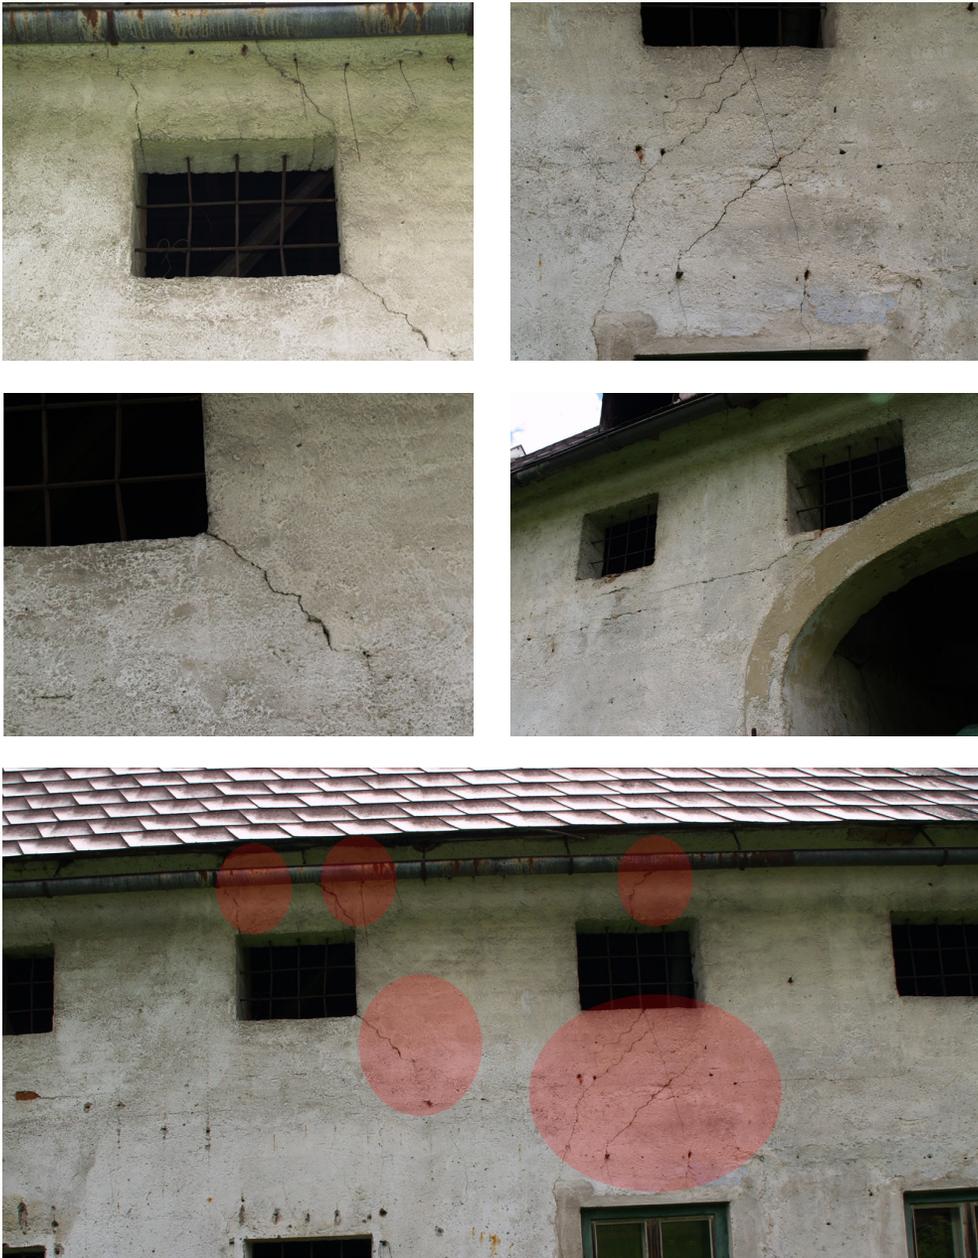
Wirtschaftsgebäude, Westseite, Fassadenrisse
